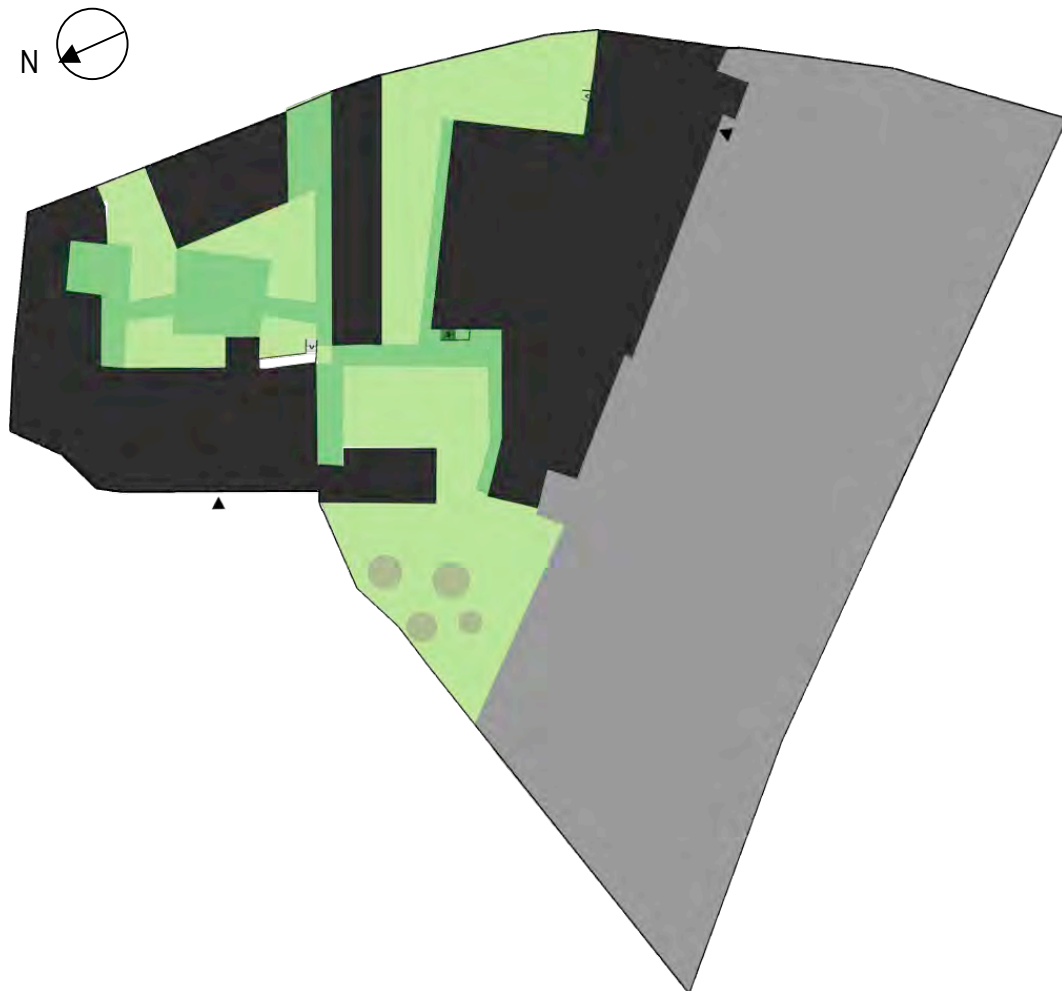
Planta geral da escola com as duas entradas assinaladas. Zonas construídas a cinza escuro. Zona de estacionamento e expansão a cinza. Zona arborizada a cinza claro. Zona de recreio a verde claro. Zona de recreio coberto a verde escuro.
